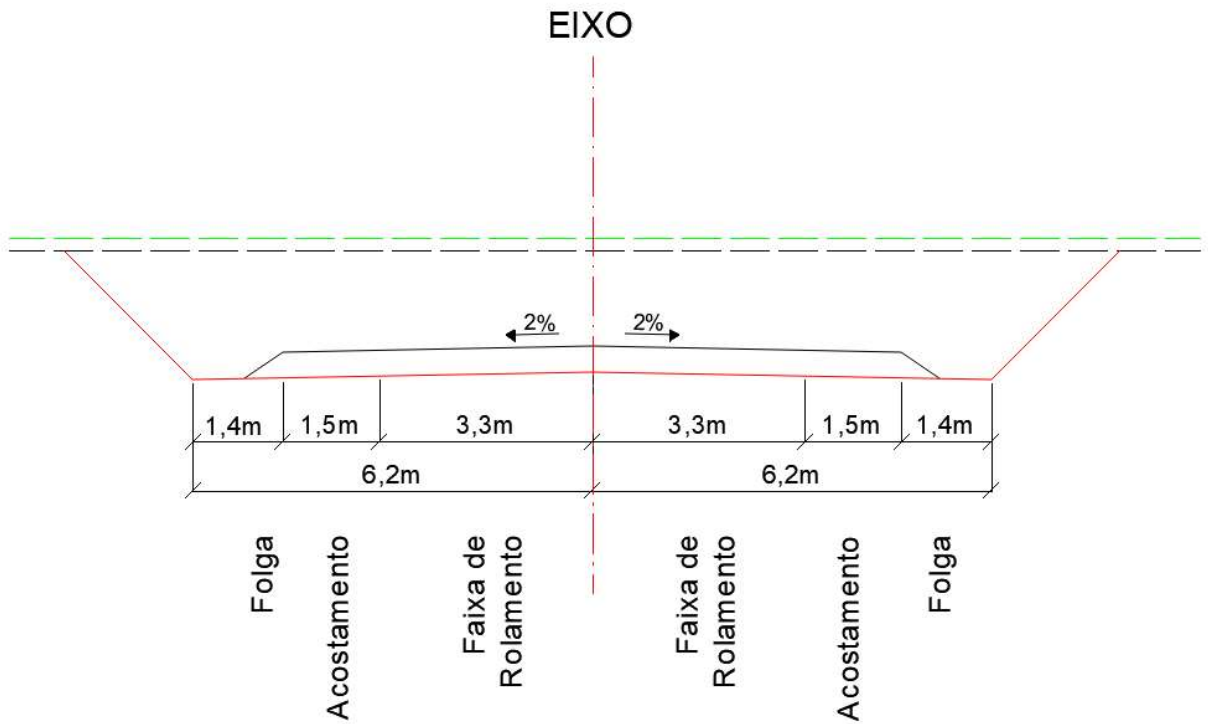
Seção Transversal em Corte (Proporção 1:1)
